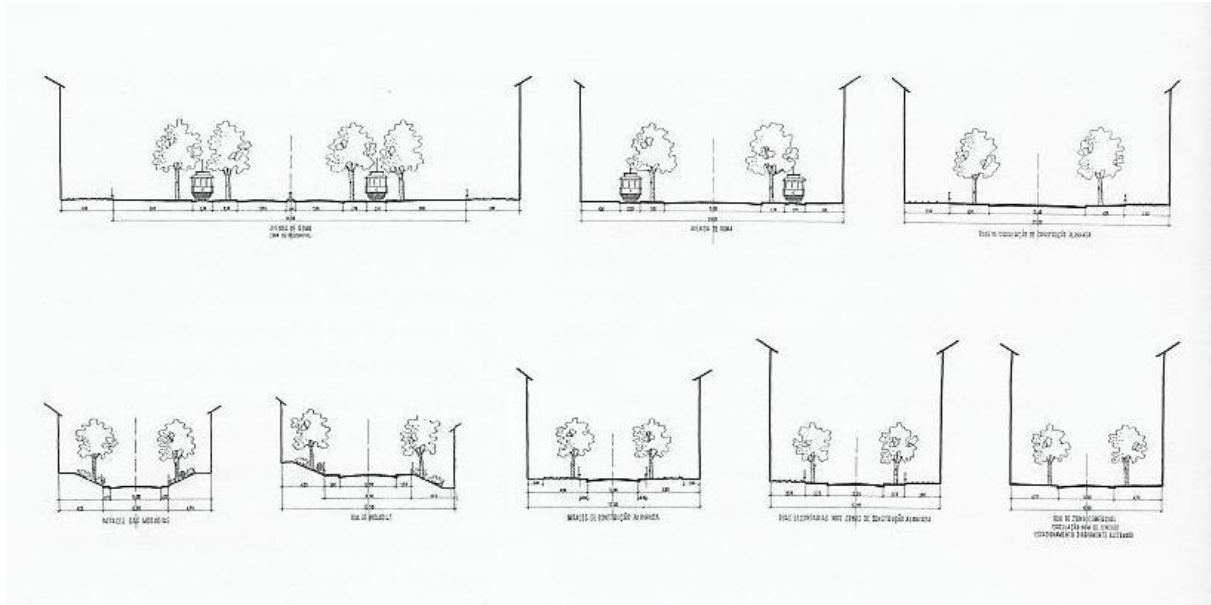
Perfis transversais de algumas vias locais, elaborados para ruas locais e ruas de atravessamento no plano do Bairro de Alvalade (fonte: Costa, 2005)
